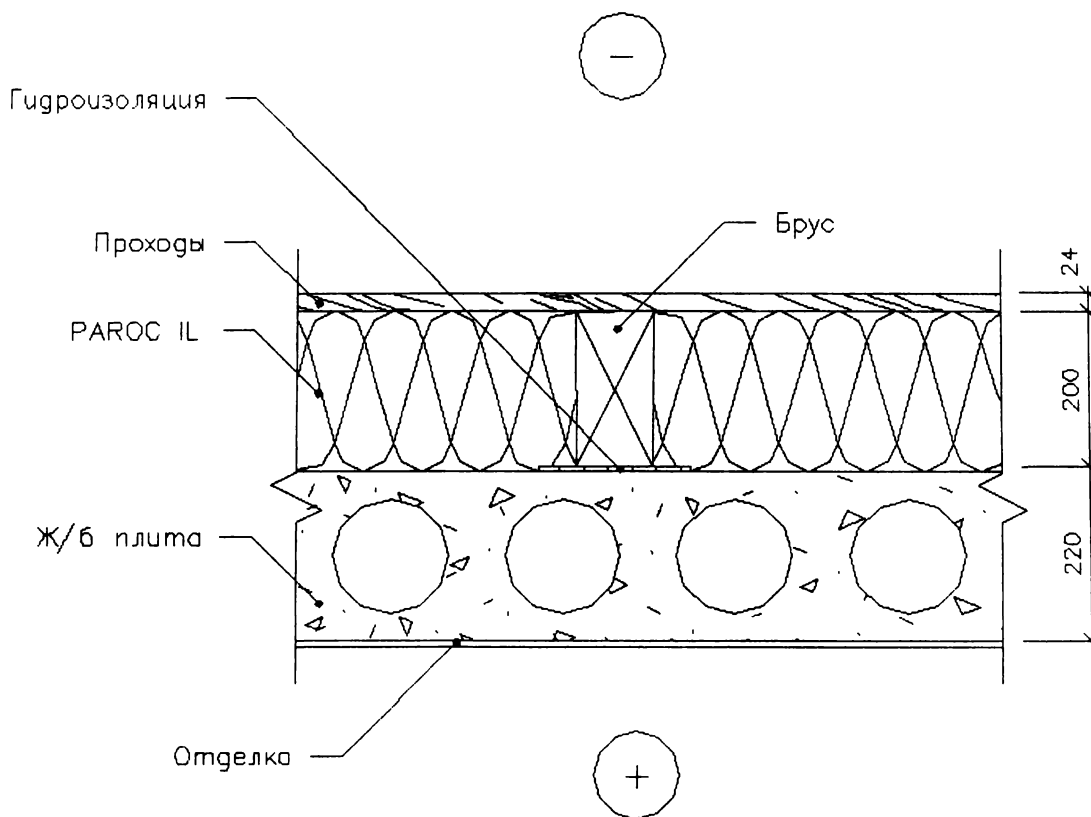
Утепление перекрытия и устройство проходов при холодной мансарде
